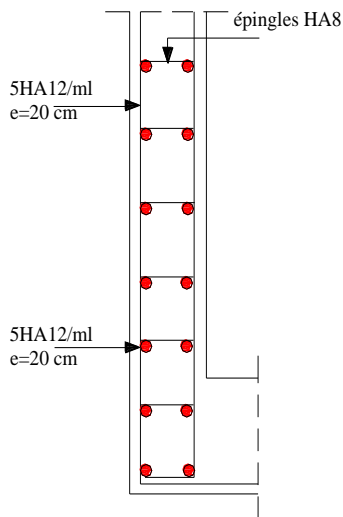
Coupe A-A' de schémas de ferrailage du mur adossé
